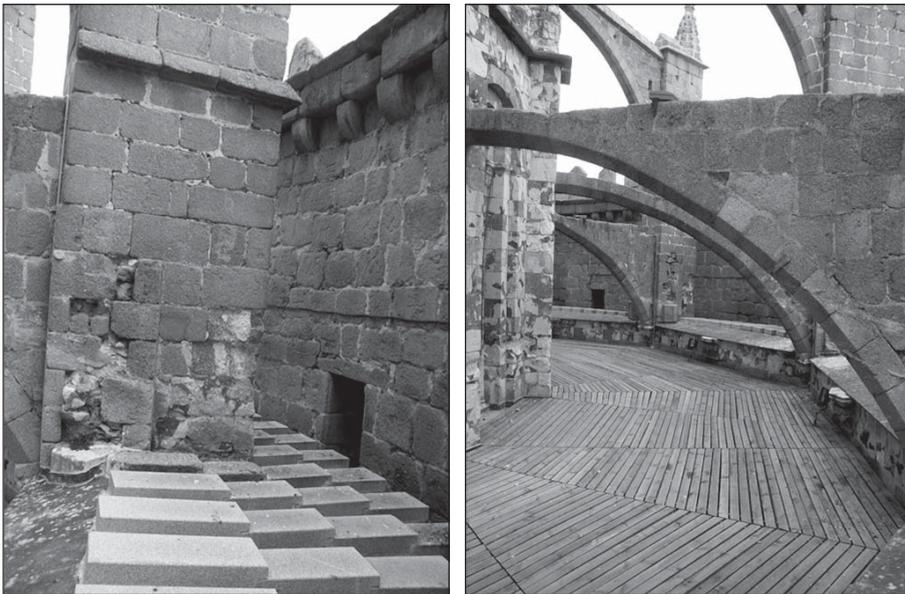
Detalle de disgregación de la piedra en la parte inferior de un contrafuerte y vista de las nuevas cubiertas planas del cimorro.
